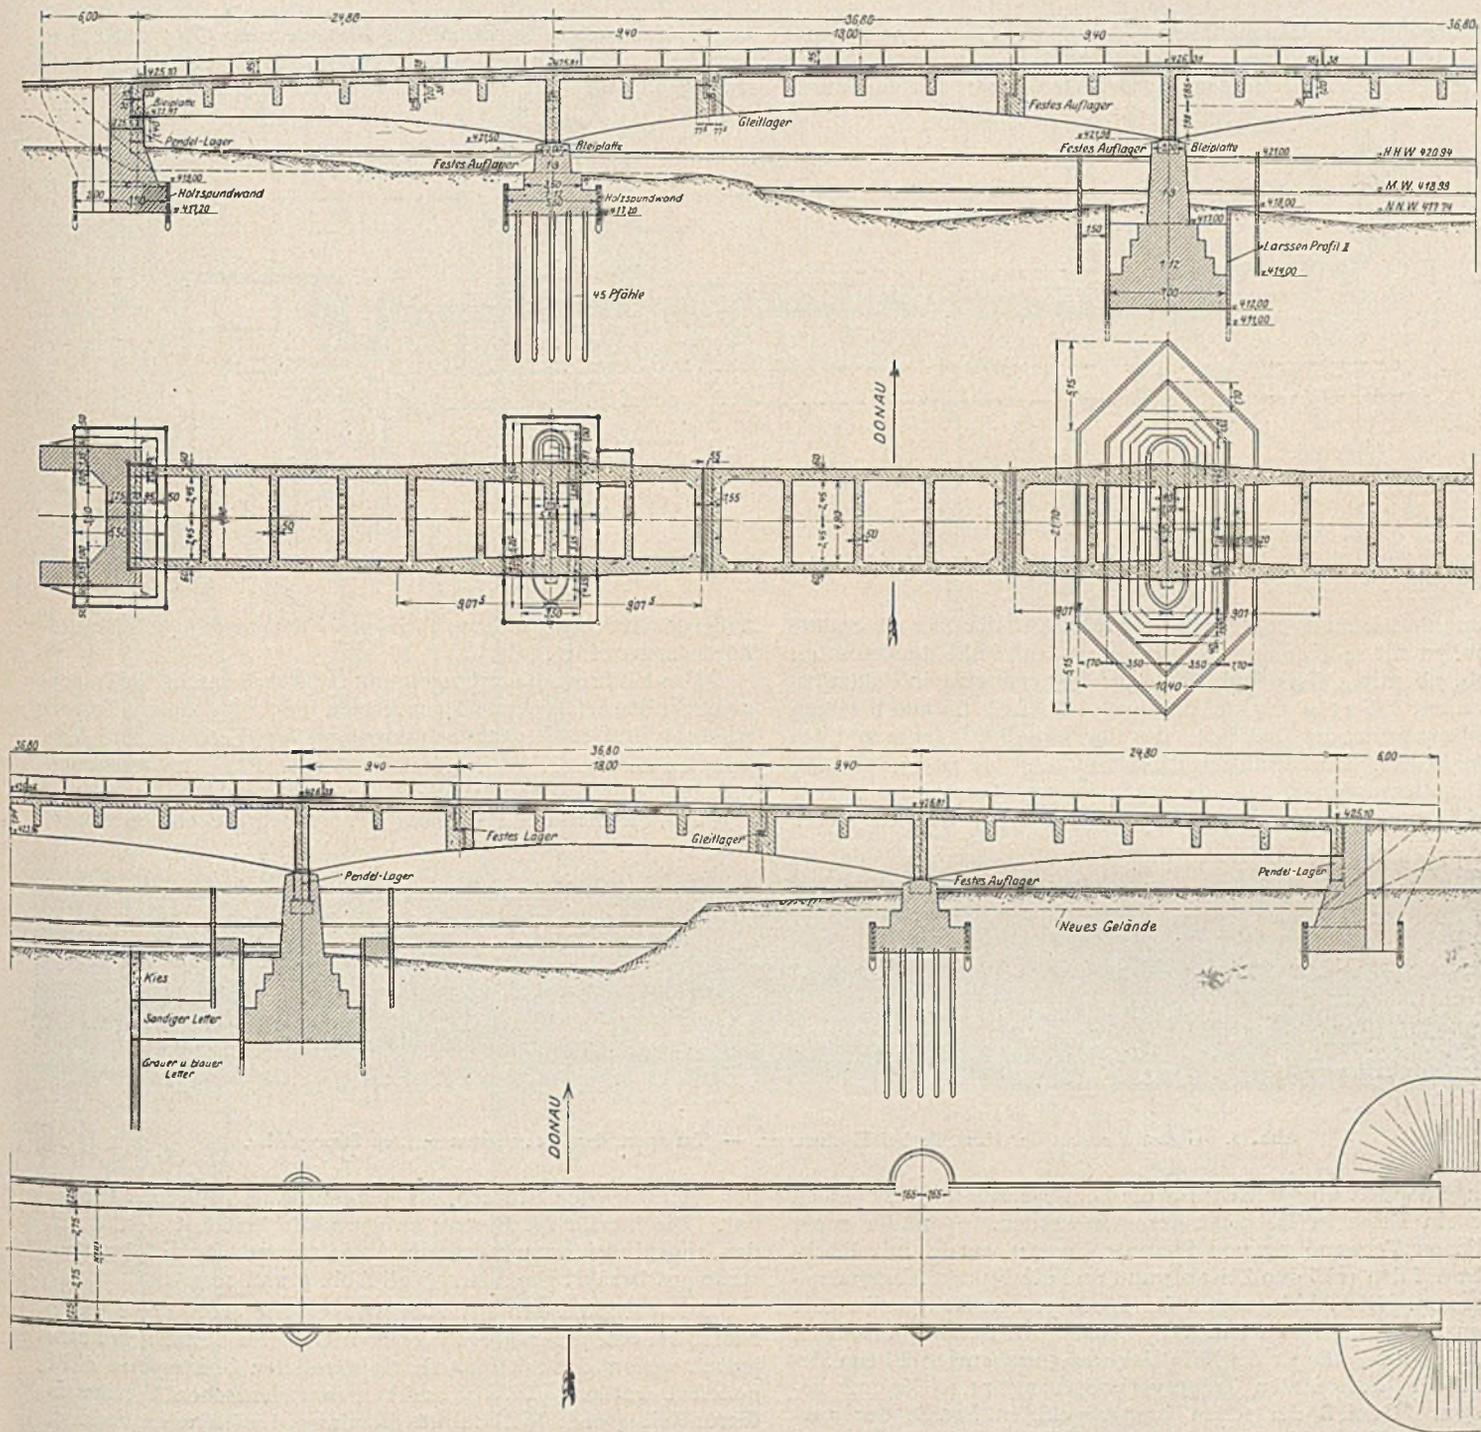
Längsschnitt, Grundriß und Draufsicht auf die neue Dillinger Donaubrücke.
